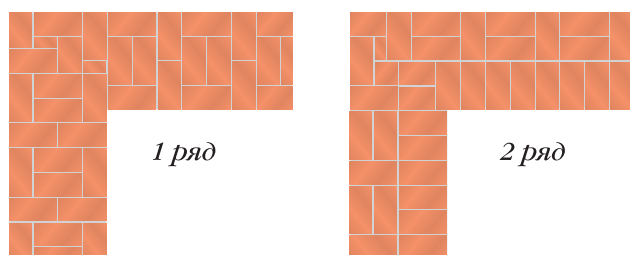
Порядовка прямых углов стен толщиной в два кирпича для готической и крестовой кладки
